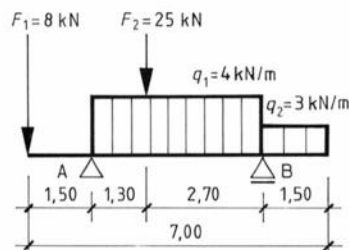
/7: Kragträger mit 2 Strecken- und 2 Einzellasten
